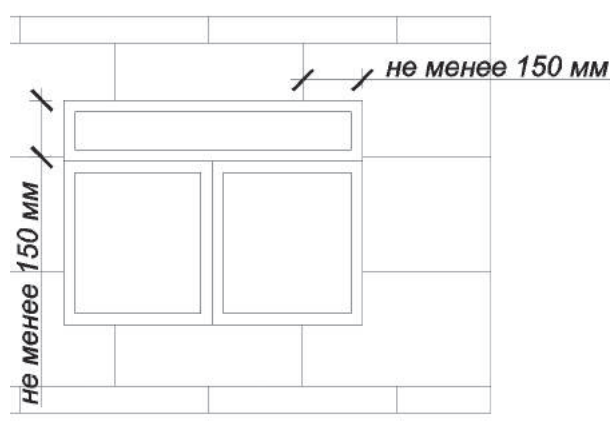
Схема монтажа теплоизоляционных плит вокруг проемов
